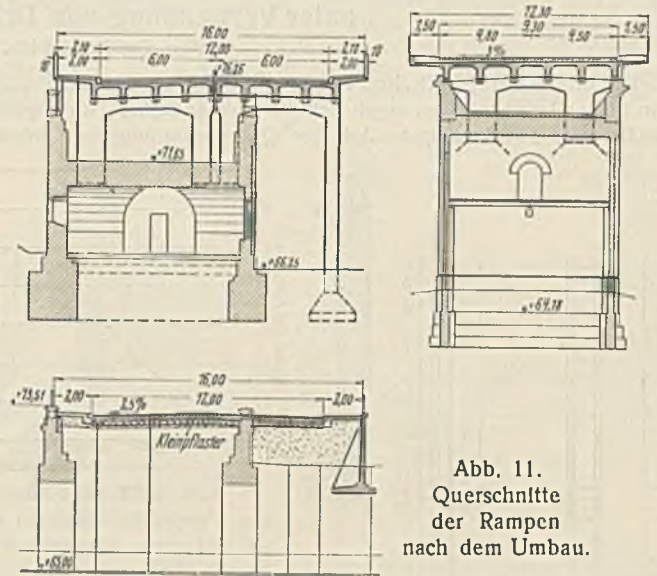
Querschnitte der Rampen nach dem Umbau.
